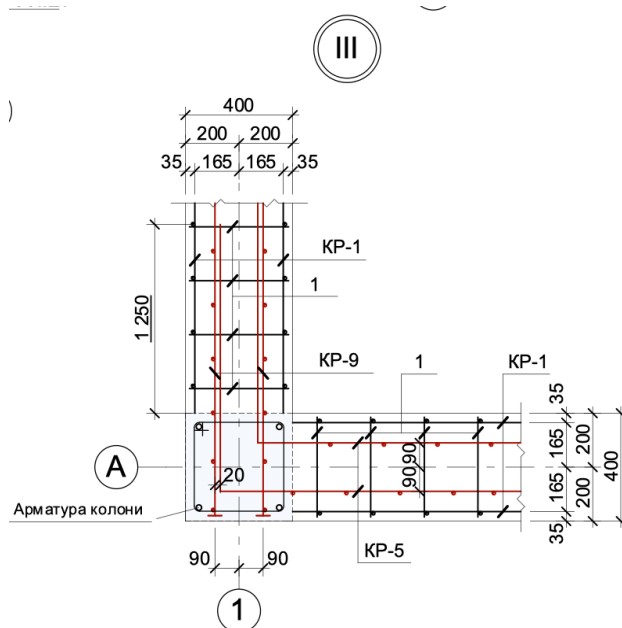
Схема розташування монолітних балок перекриття
